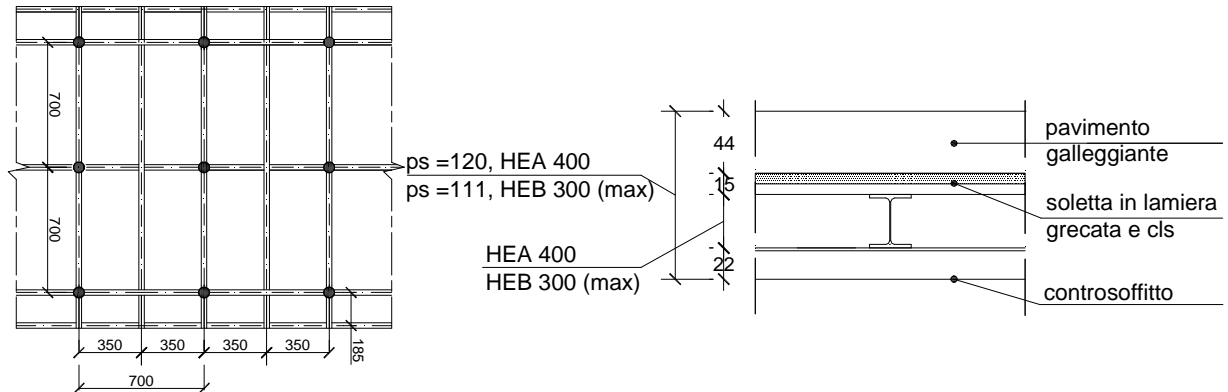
soluzione n.°2 in acciaio, pianta di piano e sezione impalcato
